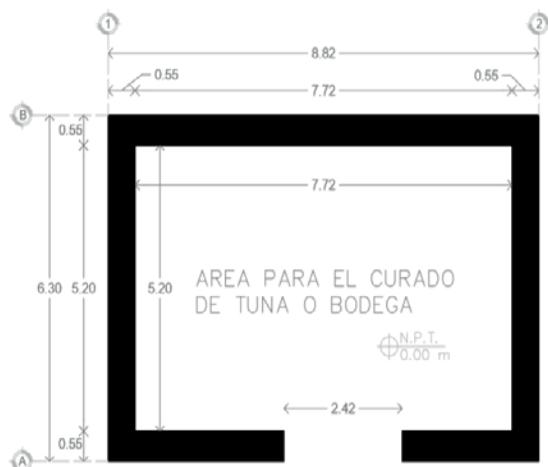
Planta arquitectónica de la bodega de piñas. Fuente: elaboración propia.
